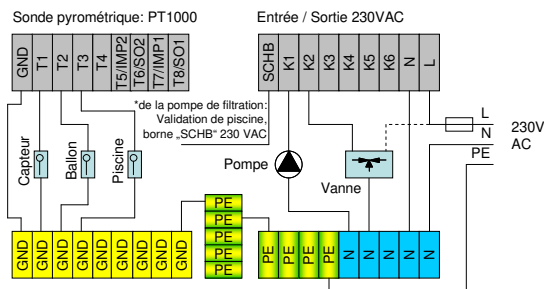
Schéma (3.1) 1F1S1WSD, plan de connexion
